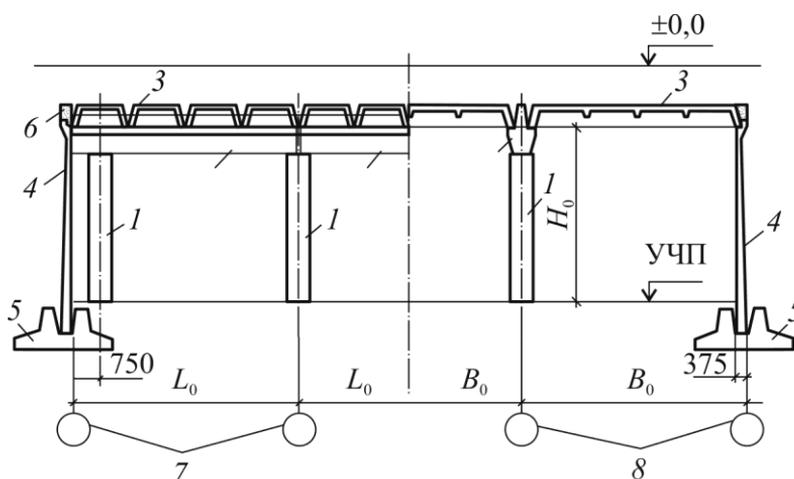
Пример конструктивного решения одноэтажного подвала: 1 – колонна; 2 – ригель; 3 – панель перекрытия; 4 – панель стеновая; 5 – фундамент стеновой панели; 6 – балка об-
